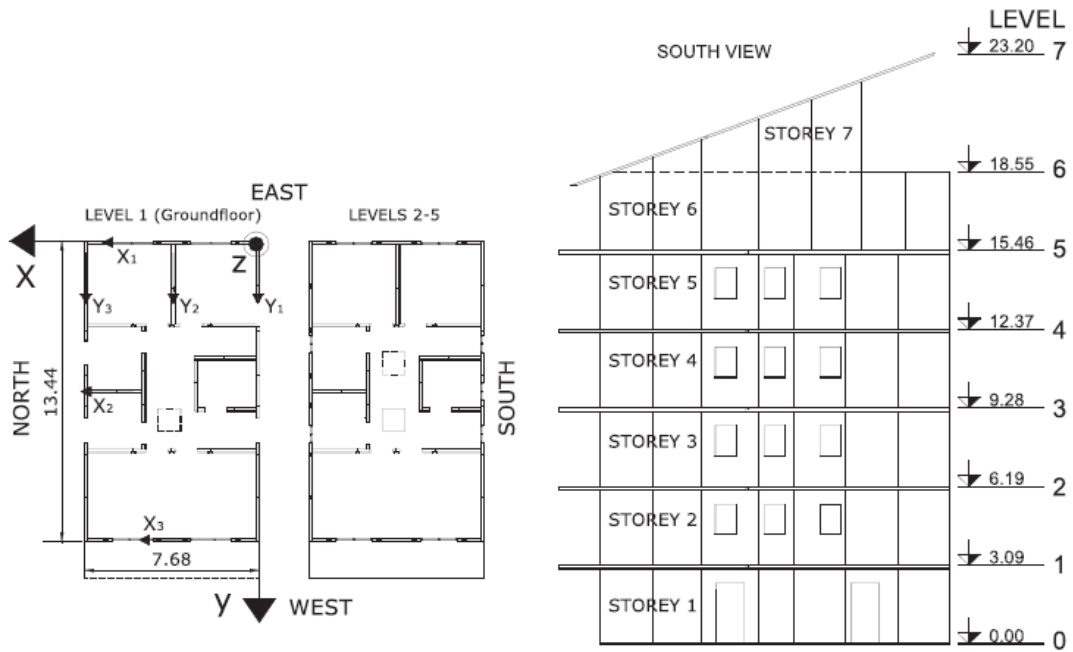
Piante e prospetti dell'edificio a 7 piani. Immagine tratta da "SOFIE project: 3D shaking table test on a seven-storey full-scale cross-laminated timber building" Ario Ceccotti et al.
